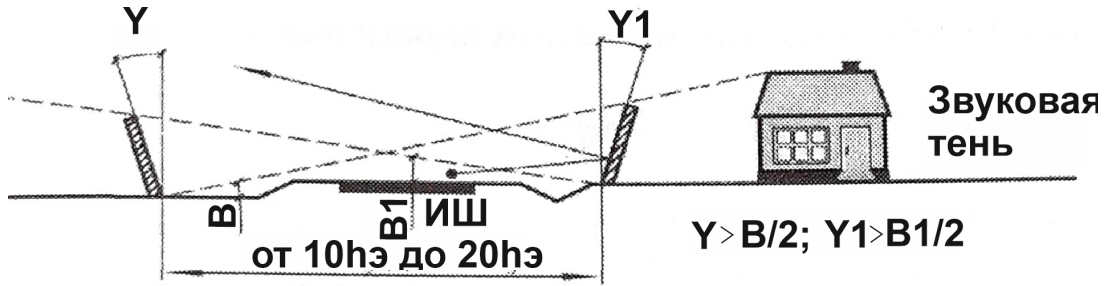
Схема с рекомендованными углами наклона экрана
